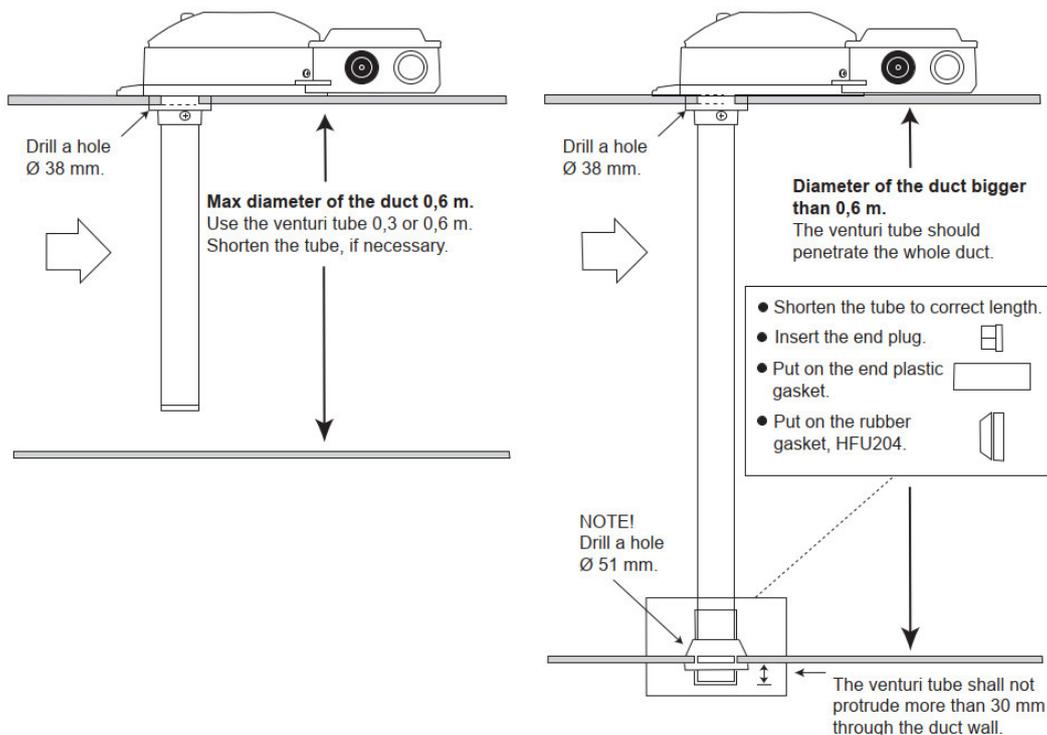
Exemple de montage d'un détecteur de fumée dans le conduit
